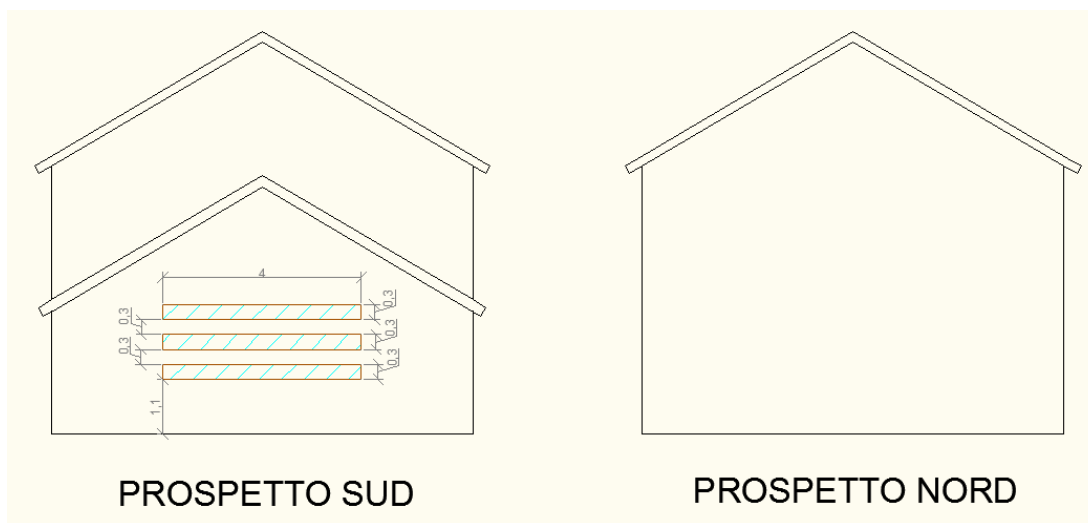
Prospetti SUD e NORD dell'edificio prefabbricato in legno.
